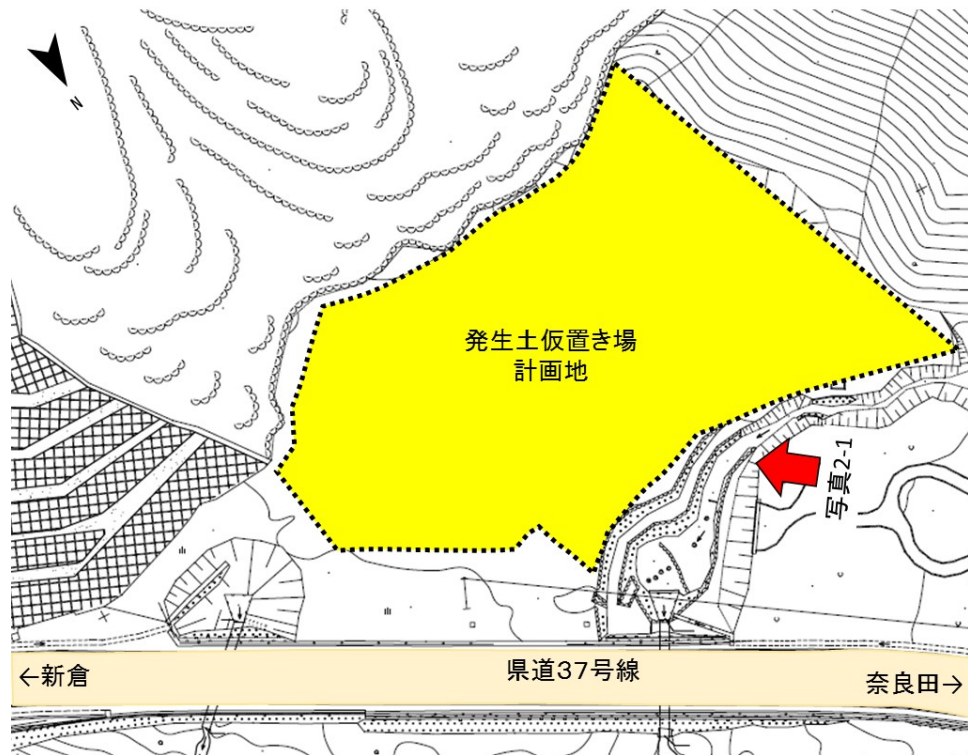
湯島地区発生土仮置き場計画地平面図 (現況)
